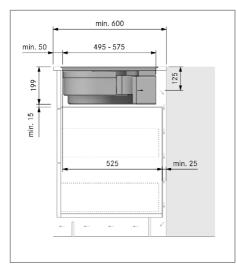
Dimensioni di montaggio con sistema filtrante variante di montaggio B, profondità piano di lavoro 600 mm
